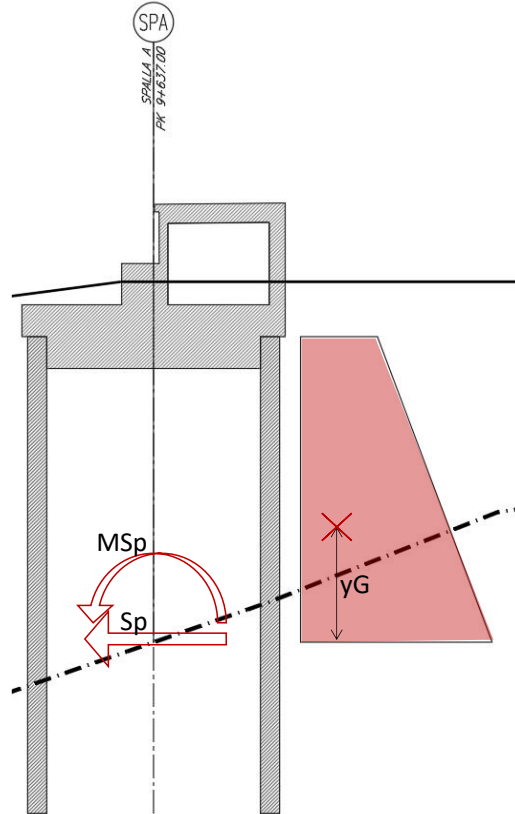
Schema applicazione della spinta delle coltri instabili al pozzo di fondazione
